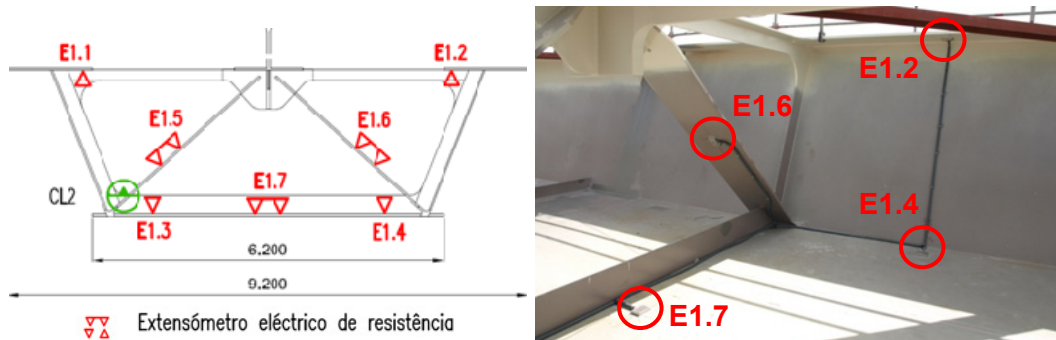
Secção instrumentada do tabuleiro (secção S1).
